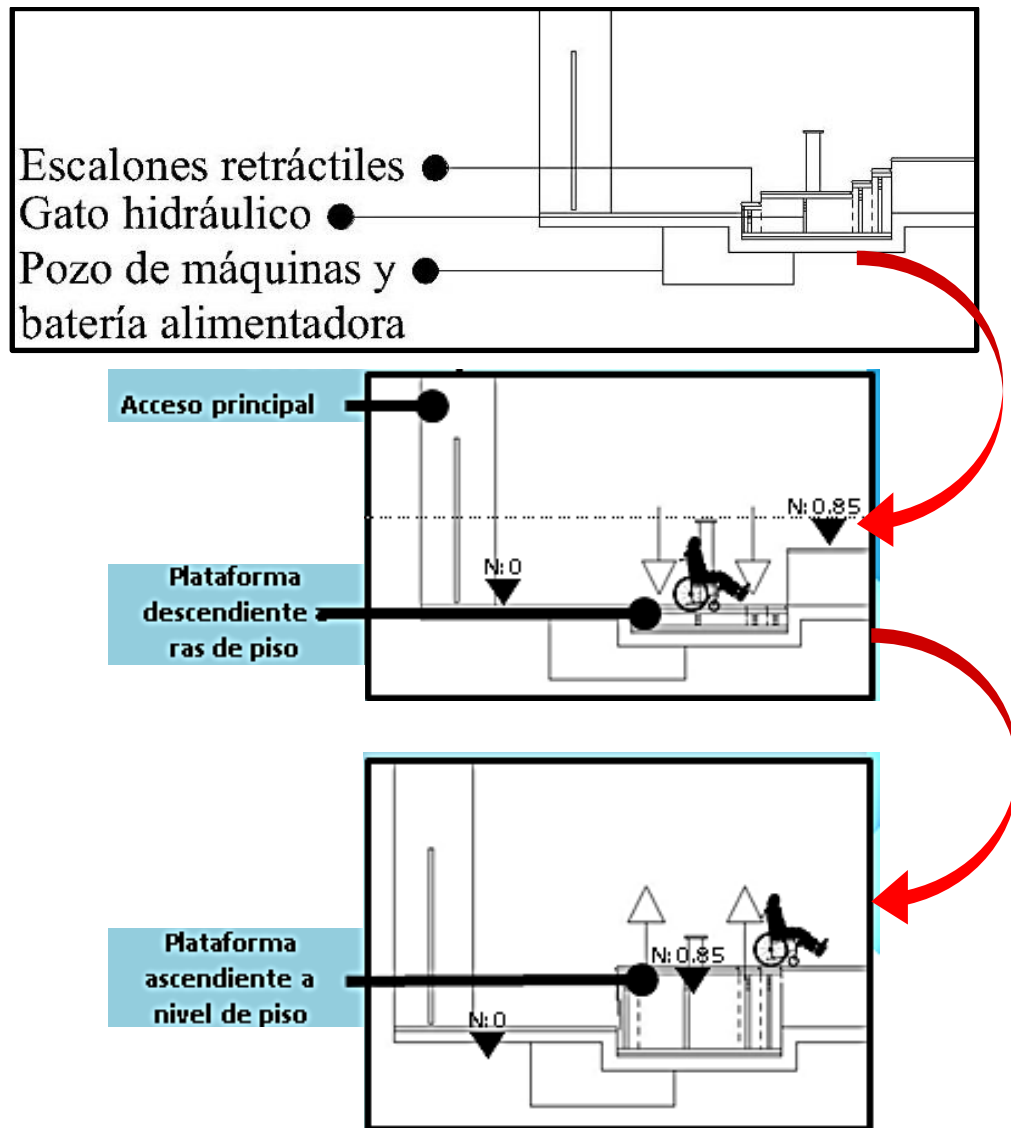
Propuesta arquitectónica en zona 1 para adaptación de salvaescalera (Fuente: elaboración propia, 2018)
